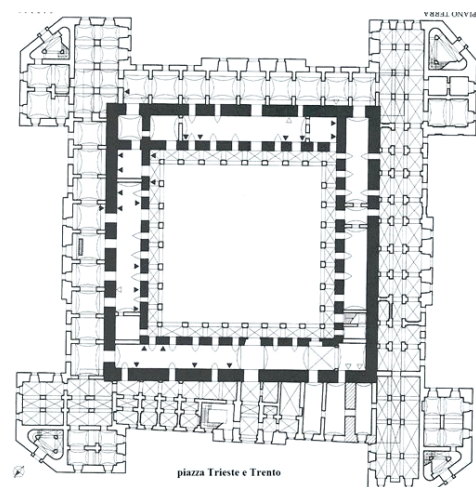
Planimetria del Quartiere di Cavalleria di Aversa.
